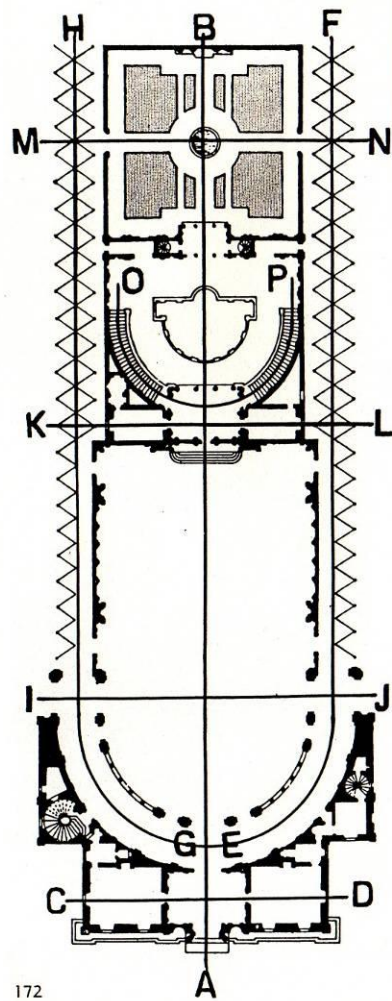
/342: plan et coupe de la villa Giulia - Risebero (48a).
